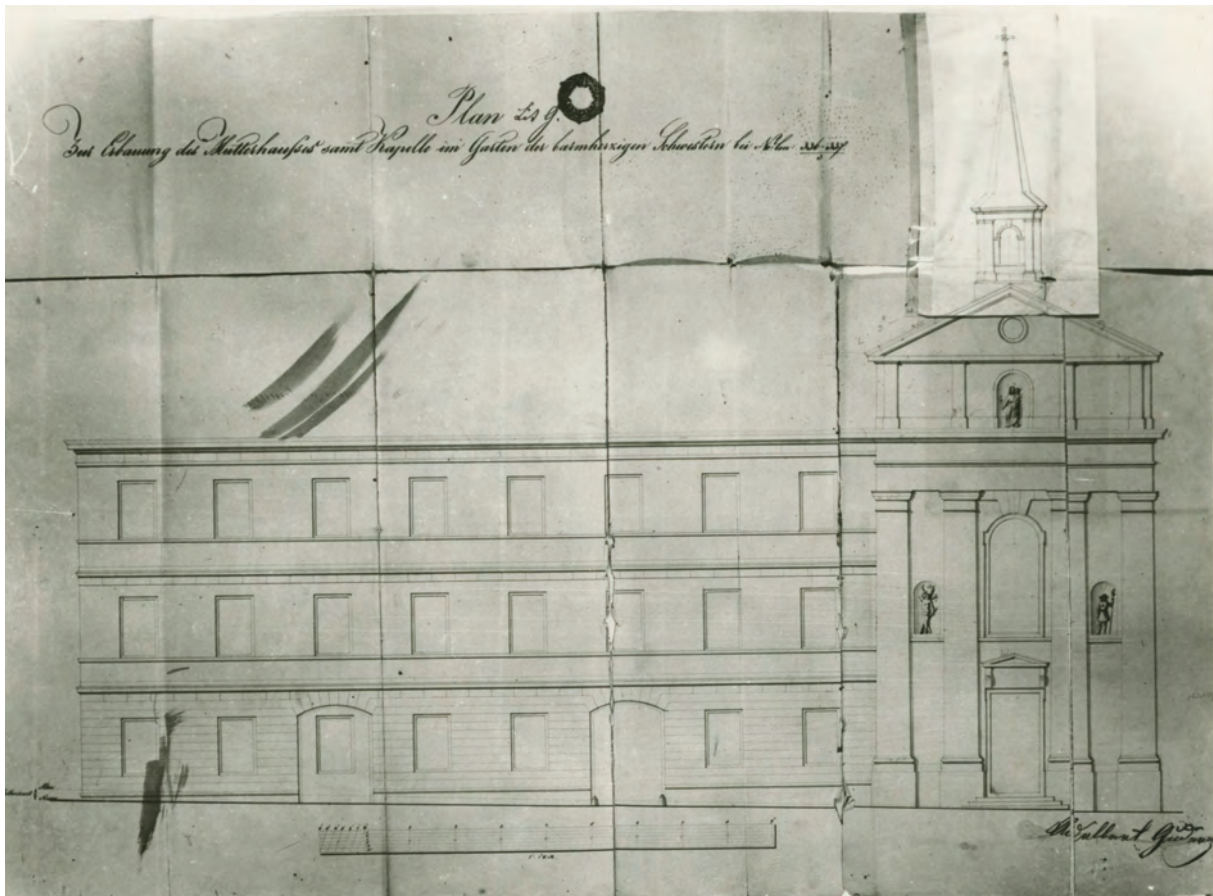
Profil-Plan zur Erbauung des Mutterhauses samt Kapelle im Garten der barmherzigen Schwestern bei Nr. 336 und 337 laut Grundrissen, Längendurchschnitt der Kapelle und Querdurchschnitt des Mutterhauses, Architekt Adalbert Gudera, 1851
